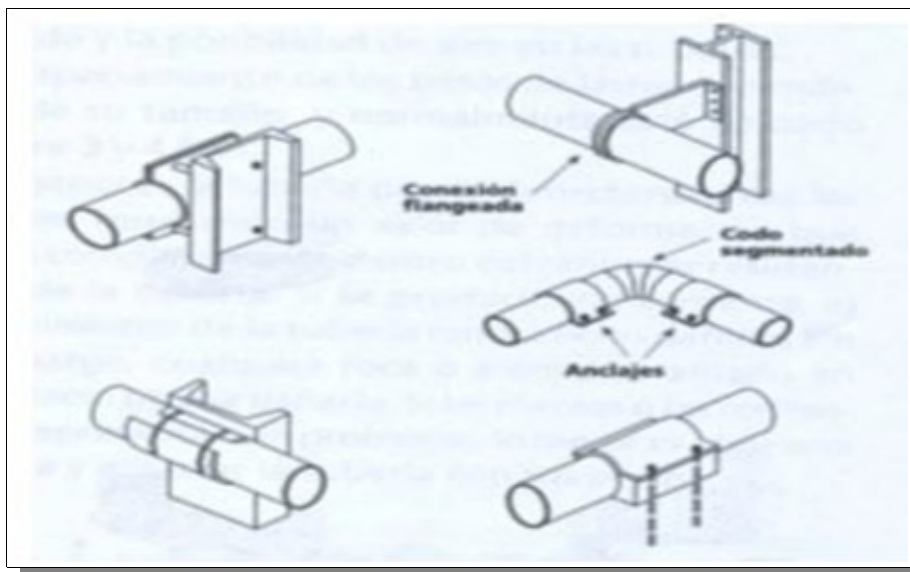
Elementos de ancoragem específicos para tubulação de PEAD
